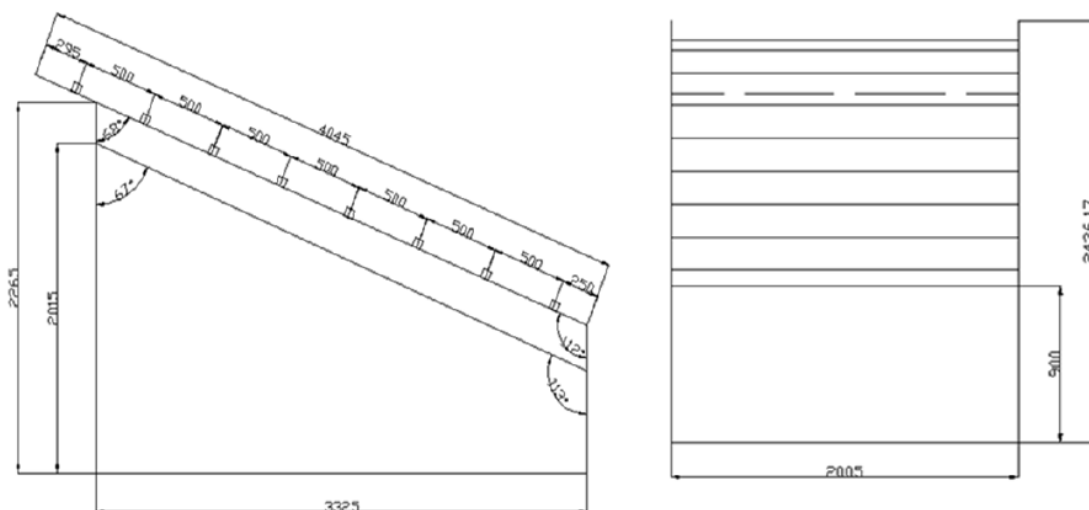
Perfil y alzado de la estructura metálica con las dimensiones en mm. (Mazón, 2014).
